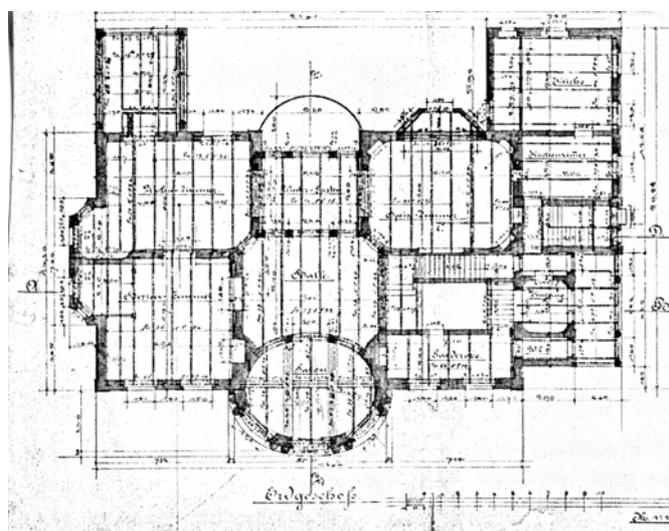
H. Plange, Haus Kortenbach, Solingen, Grundriss Erdgeschoss, 1908
